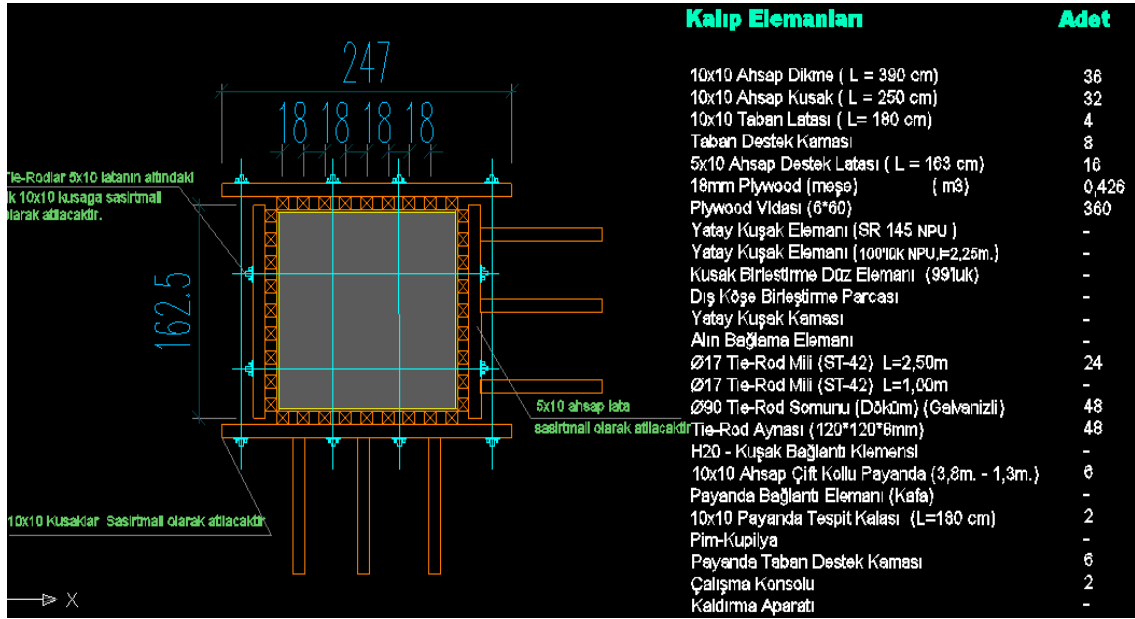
1 adet endüstriyel tipi kolon kalıbının yerleşim planı ve adetleri
